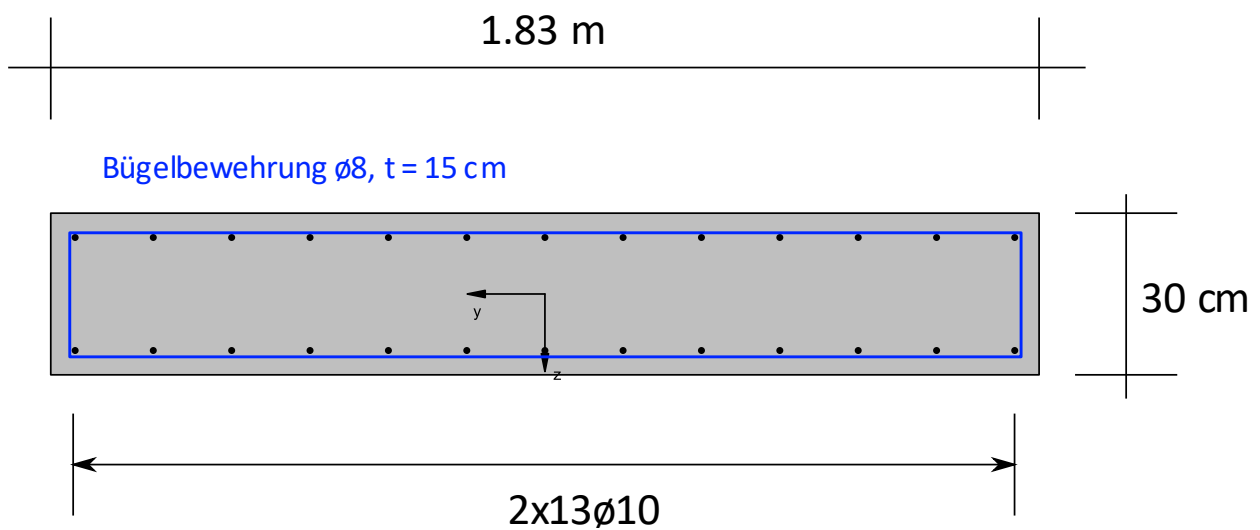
Geschätzte Bewehrung Betonwand BW1 Eingangshalle
